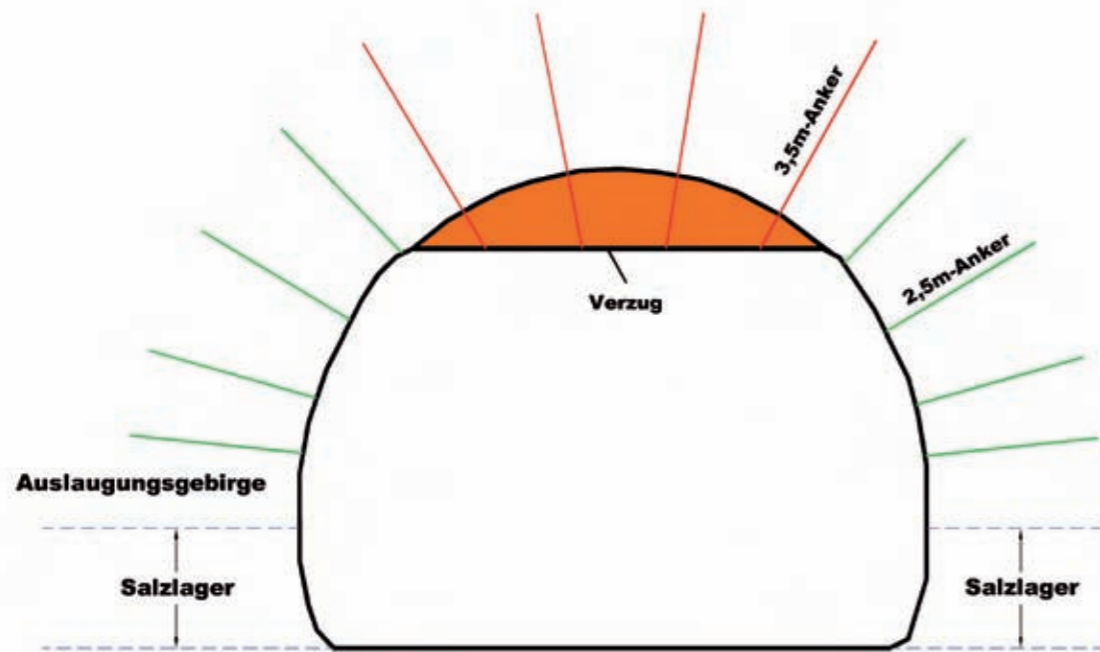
a: Streckenprofil mit Ausbauplanung und Umsetzung / Section profile with development planning and implementation
